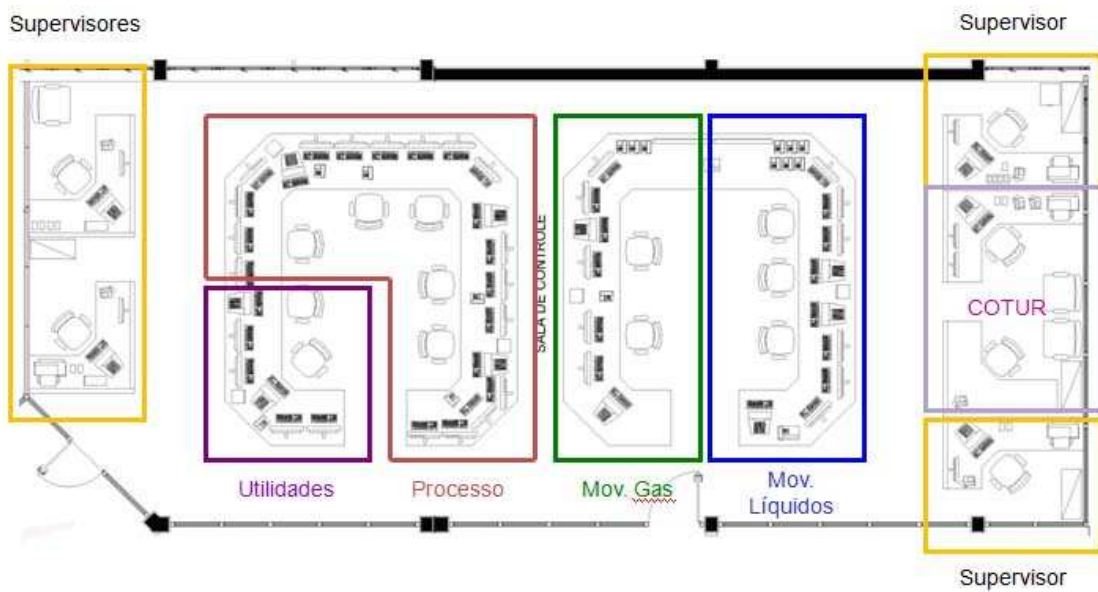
Planta baixa da sala de controle, apresentando a localização das equipes
